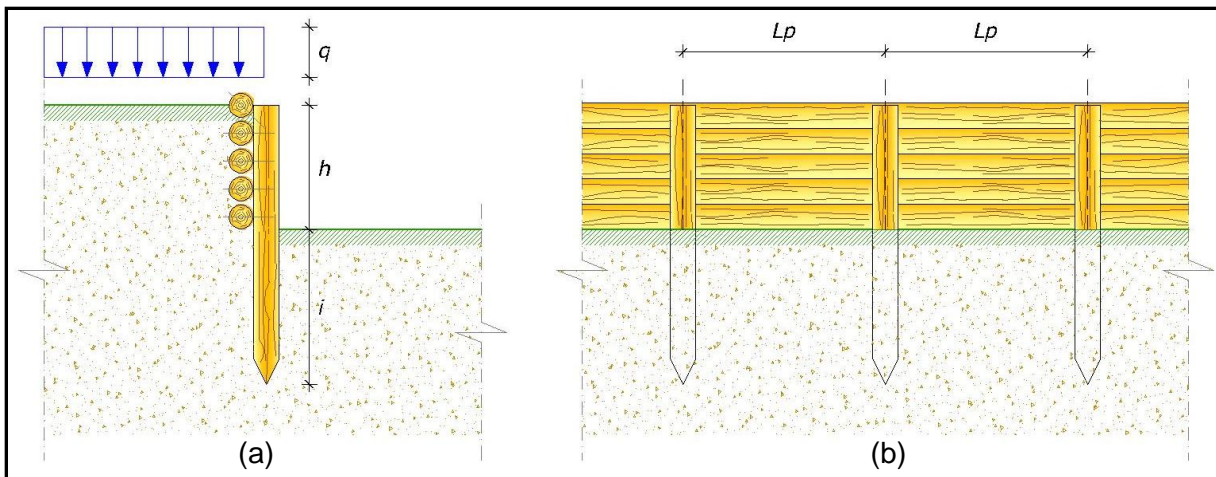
Sezione (a) e prospetto (b) di una palizzata in legno.
